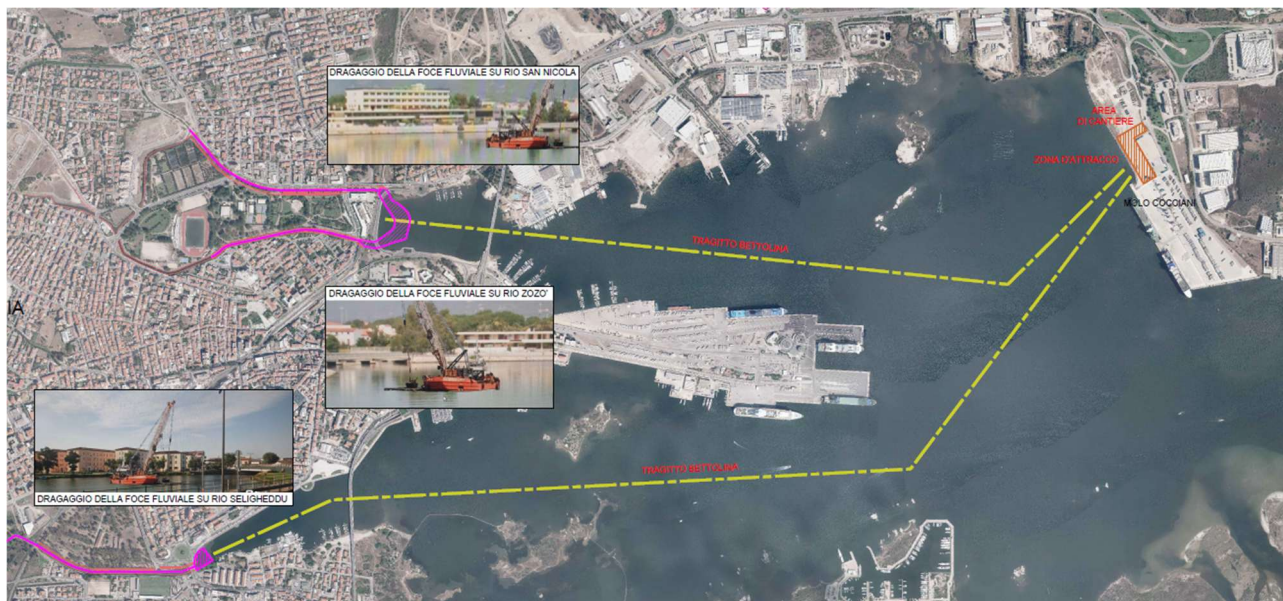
Tragitto delle bettoline dalle foci alla banchina Cocciani
